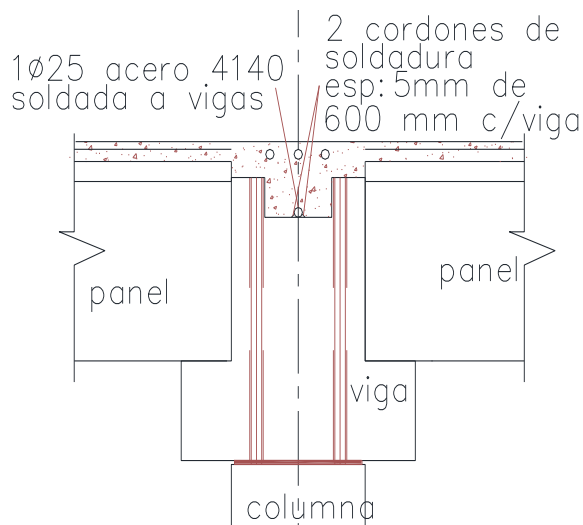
Armadura de carpeta de compresión en uniones de viga.
